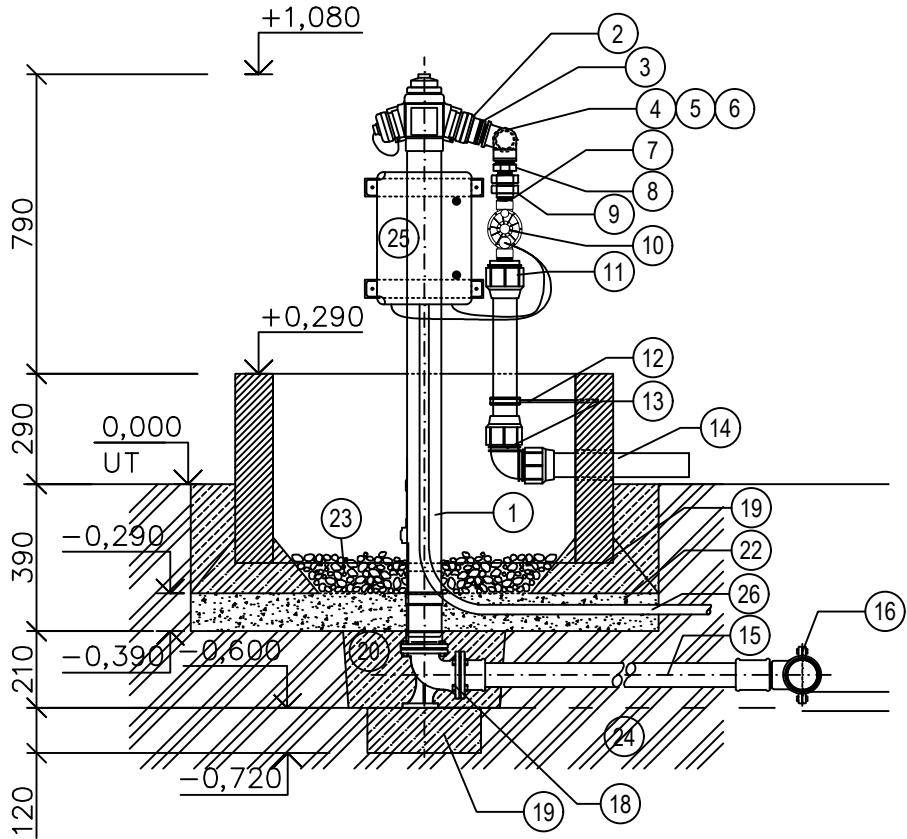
DETAIL HYDRANTU – POTRUBÍ V NEZÁMRZNÉ HLOUBCE
